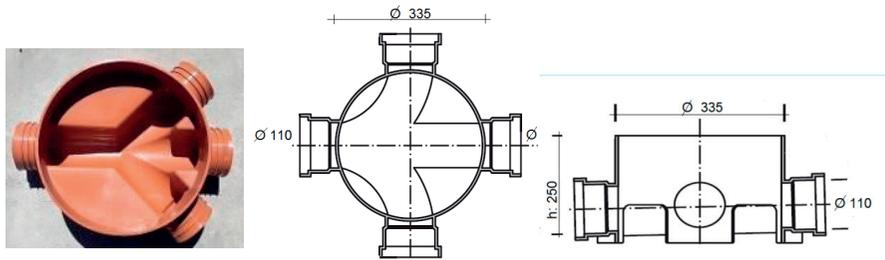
Cámara de Inspección de Polipropileno. Vista, planta y corte.
